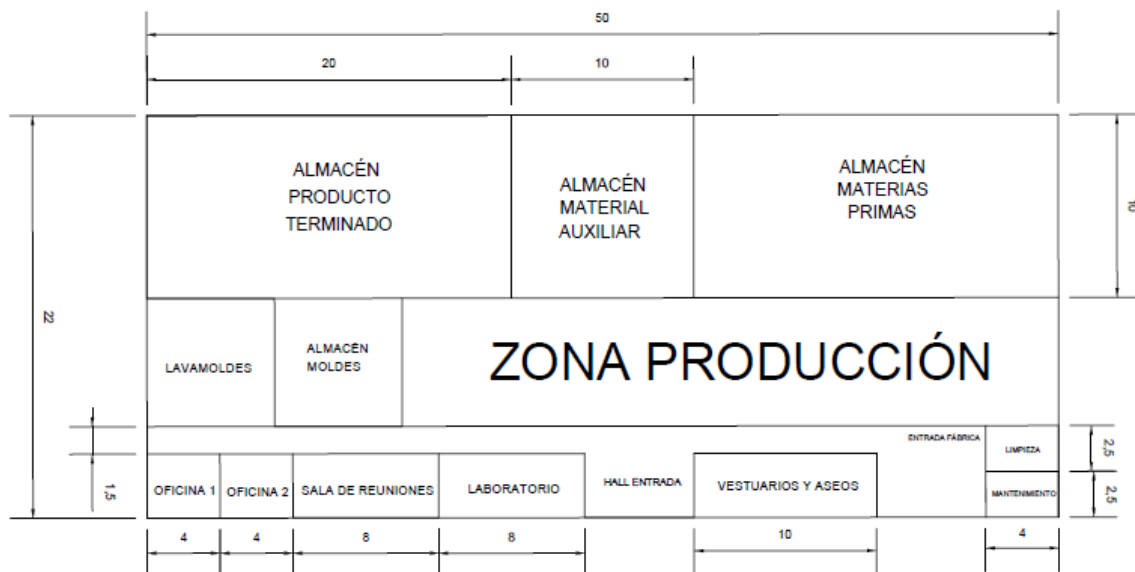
Distribución en planta de la nave industrial. Fuente: Elaboración propia
